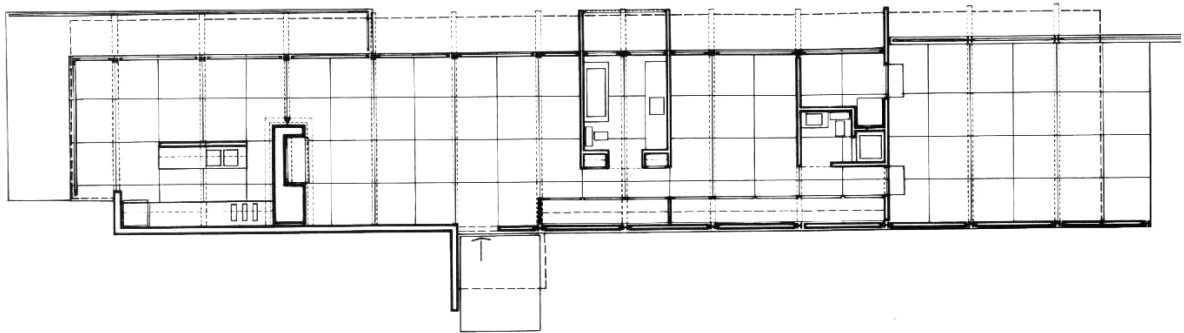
Planta: la cubierta unificadora, unida al liviano entramado horizontal estructural, ambos de madera, hacen de la casa un escenario vacío ideal para una vida flexible.
